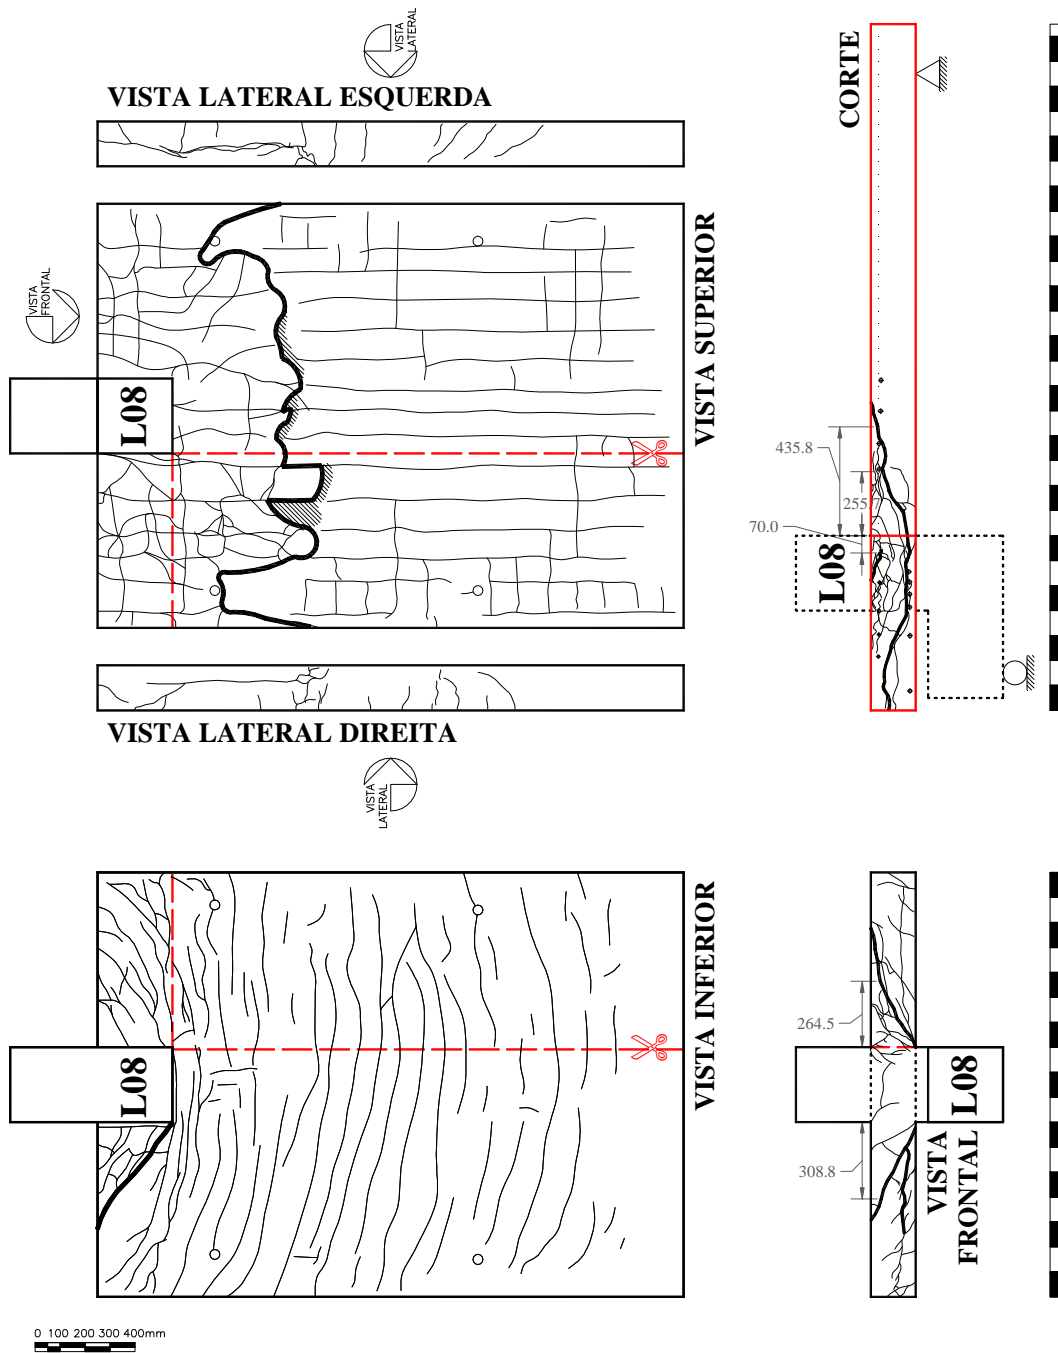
Padrão de fissuração da laje L08
